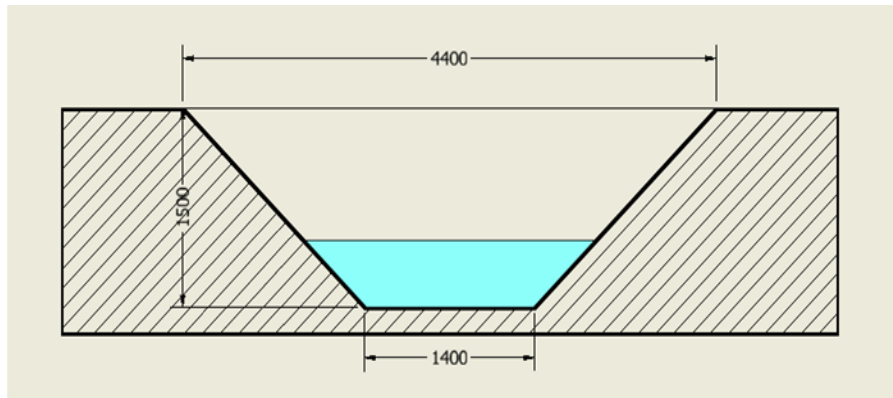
Perfil del Canal Paso de las Carretas, acotado en milímetros. Adaptado de [12]
